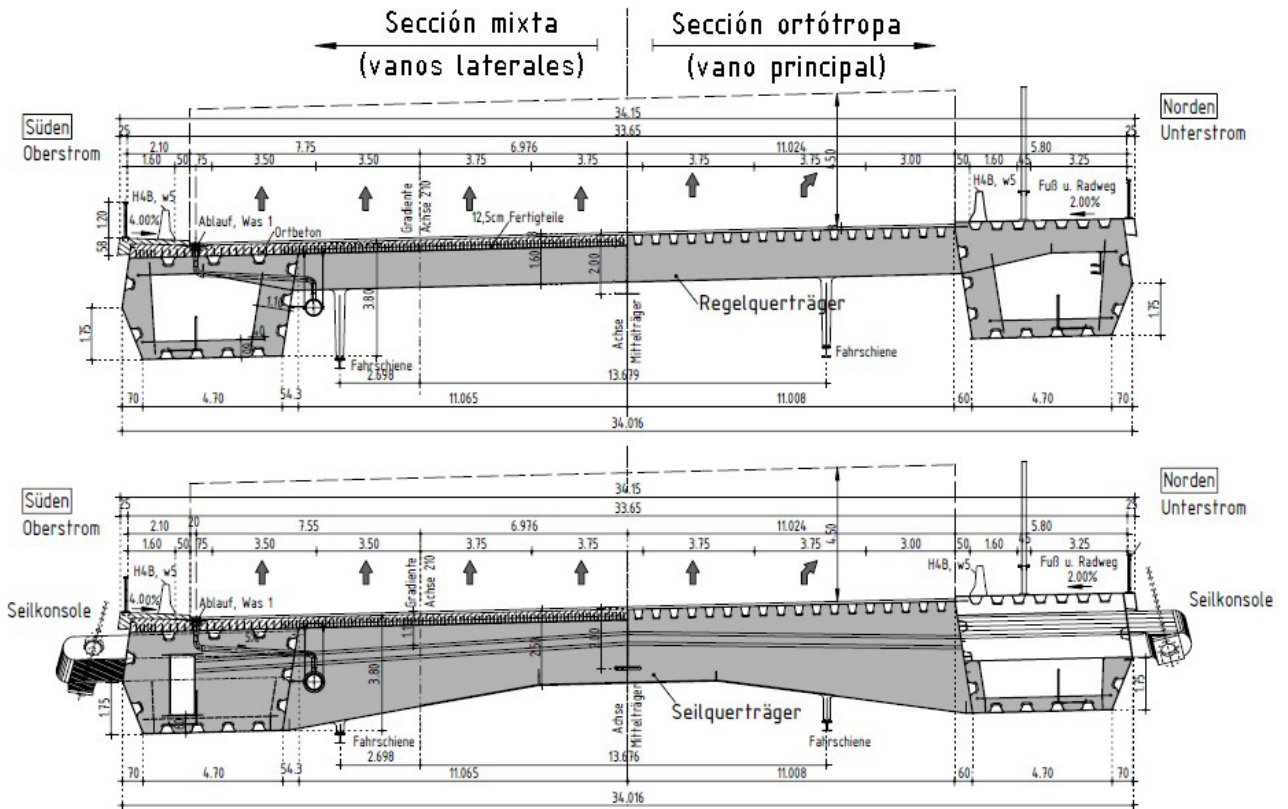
Secciones transversales por viga transversal típica y por viga de anclaje de cables (LAP).
